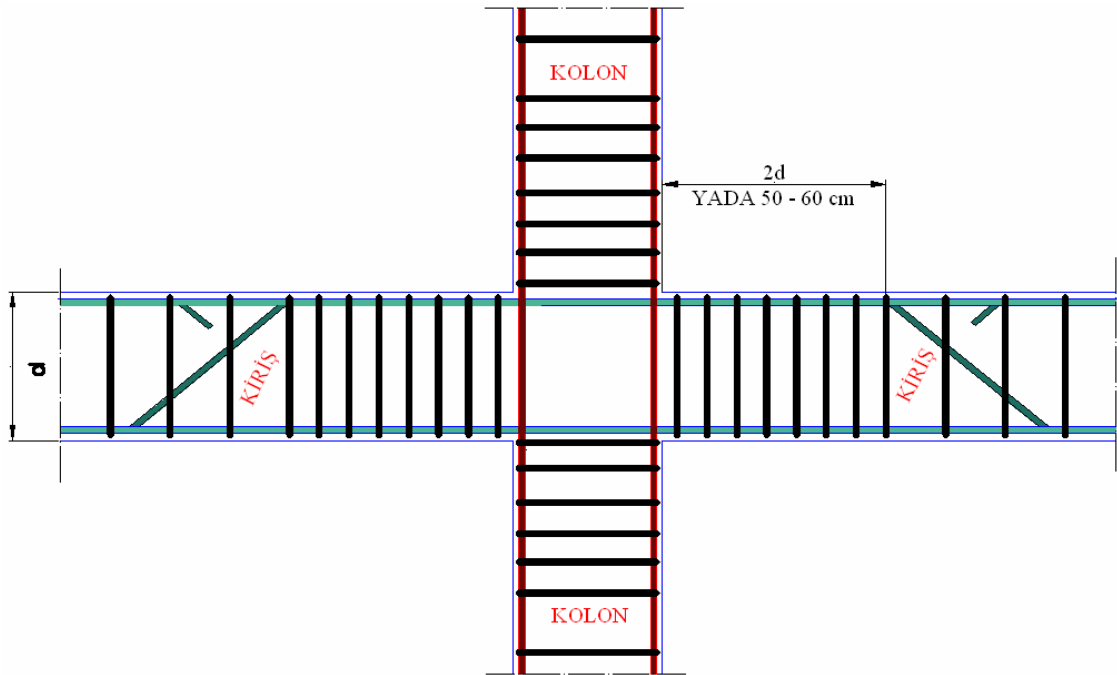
İç ve dış aks kolon – kiriş birleşmesinde kiriş uçlarında donatı sıklaştırılması
